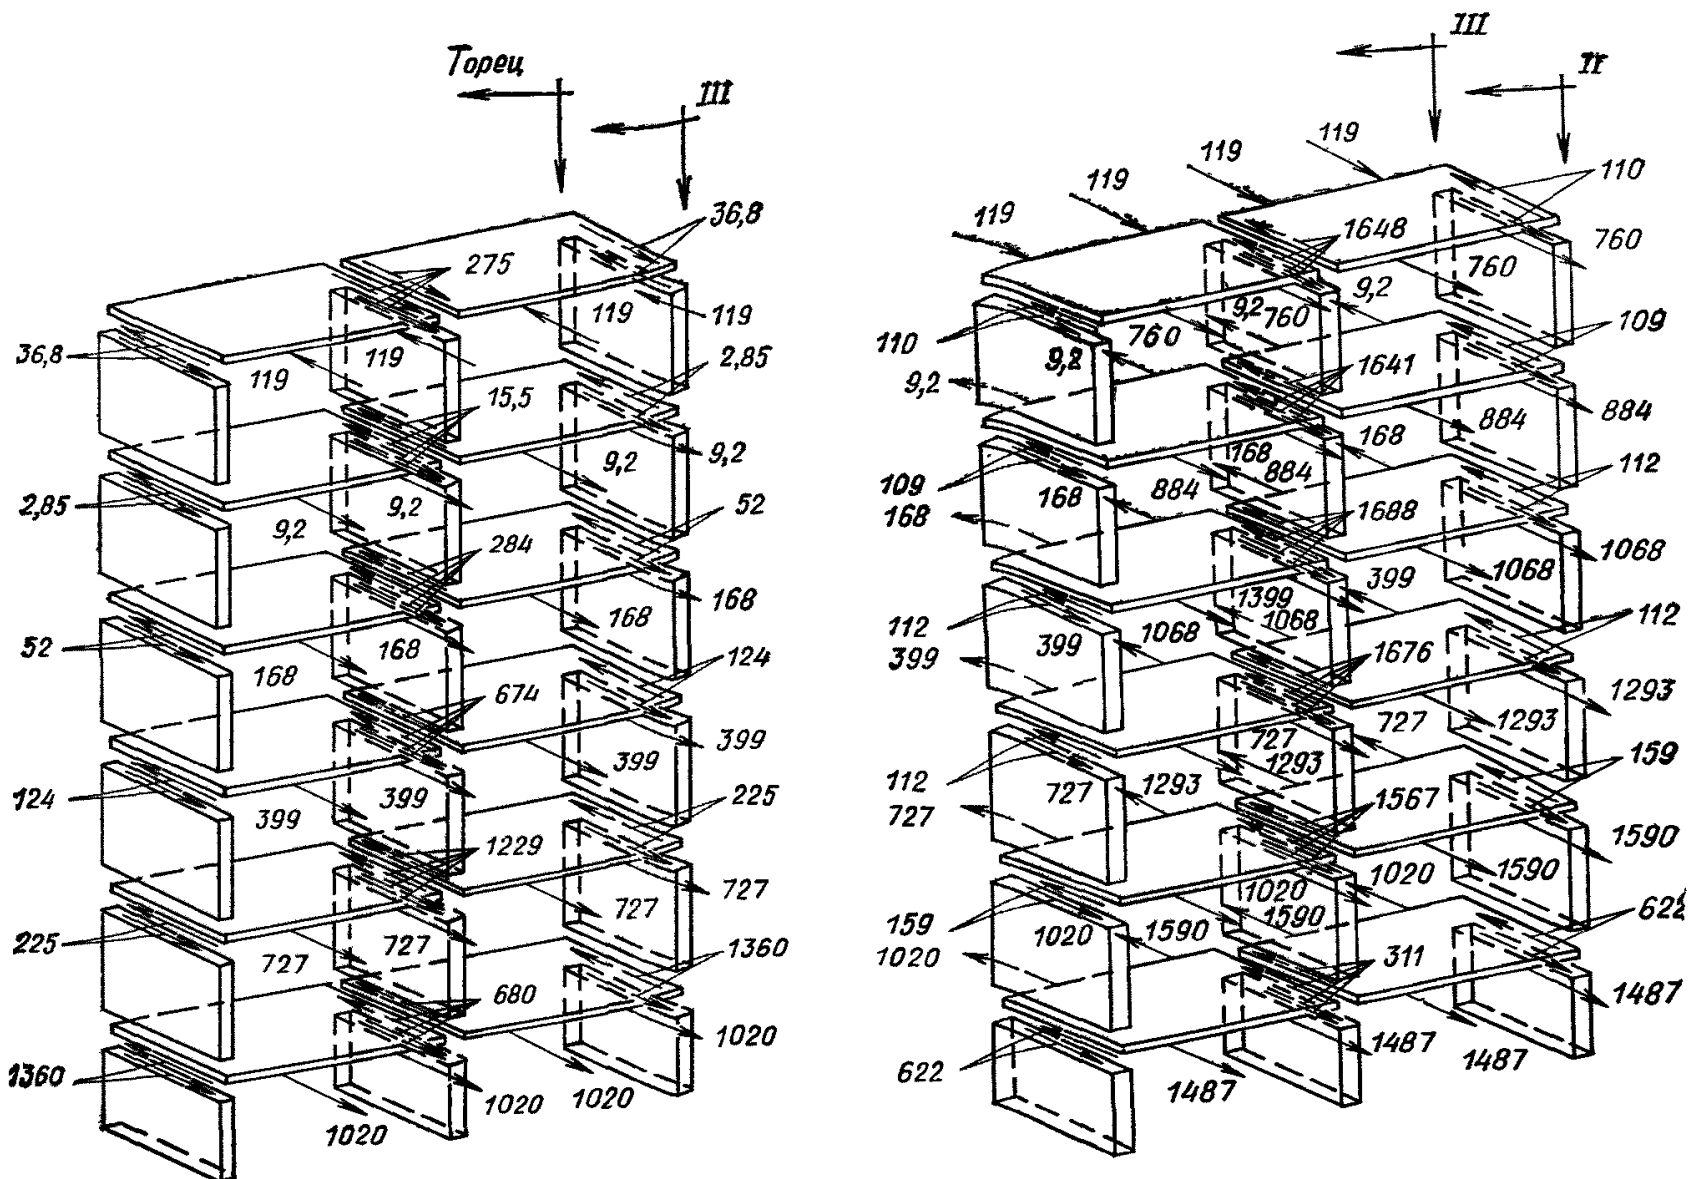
Растягивающие усилия в перекрытиях и усилия взаимодействия между перекрытиями и продольными стенами (в кг)
